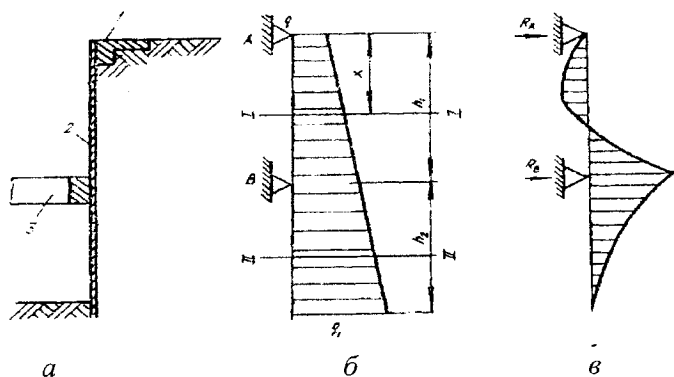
Розрахункова схема тонкої заанкереної нерозрізної стіни з двома опорами: а – конструктивна схема; б – схема навантажень; в – епюра згинальних моментів; 1 – верхня опорна рама (комір траншеї); 2 – стіна; 3 – проміжна опорна рама (кільце)
